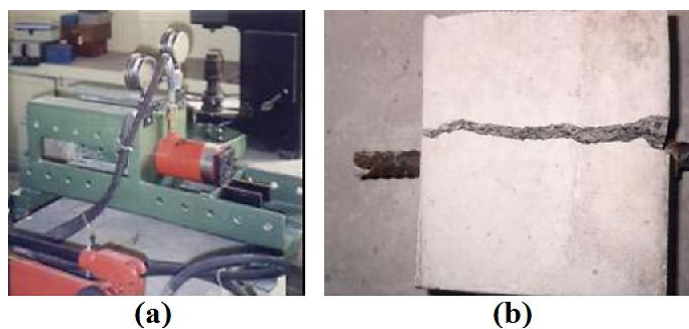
(a) Configuração do ensaio de arrancamento, (b) Forma de ruptura do corpos de prova - Barbosa & Filho (2013).
